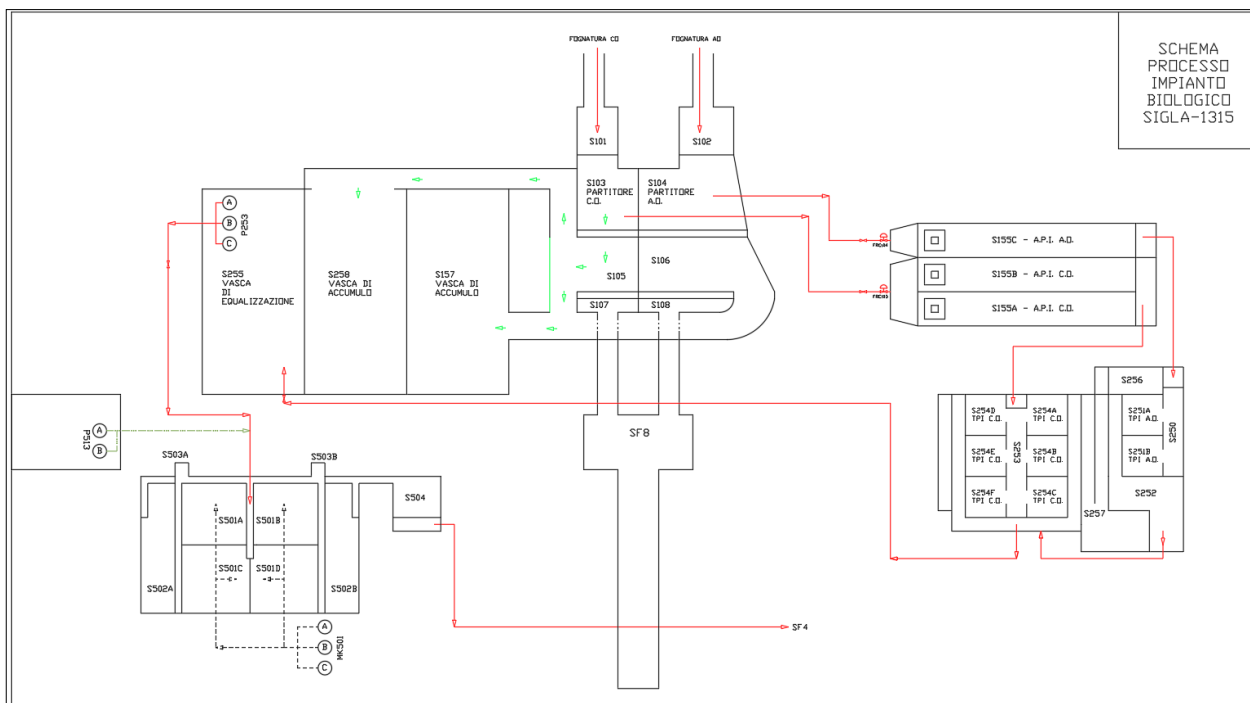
Planimetria del futuro assetto Vasche TAS dell'impianto.
